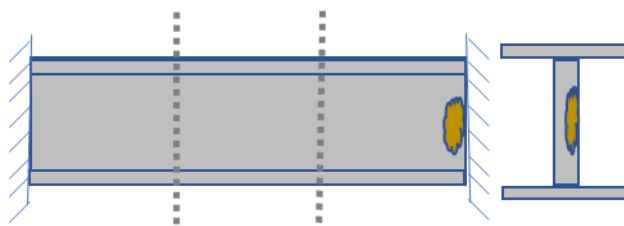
Amostra6 (Localização do dano na extremidade da viga, apoios)
